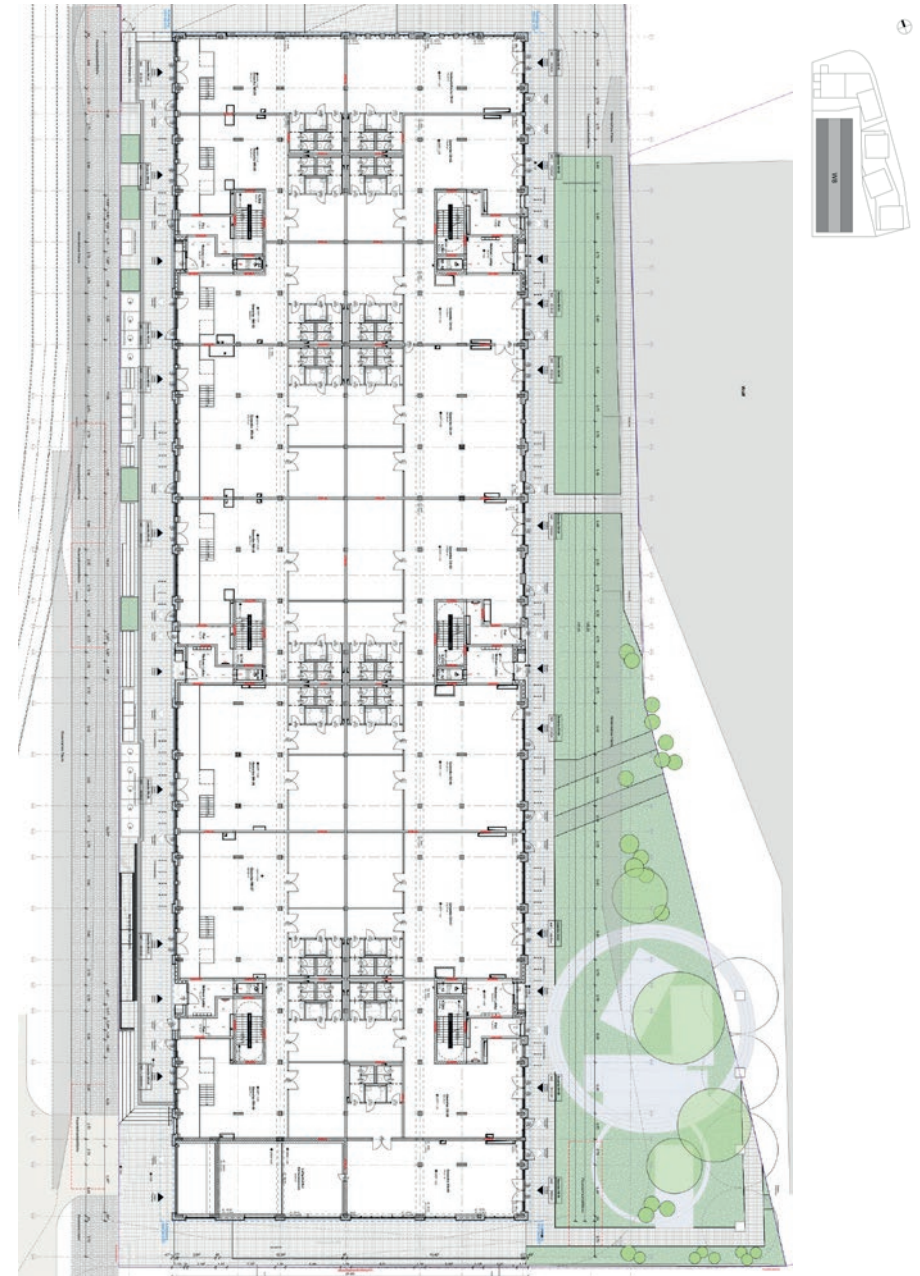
Grundrisse EG Neubau Werftbahnstraße, Baufeld B- W8 (MVRDV, Stand 11.08.2022)
